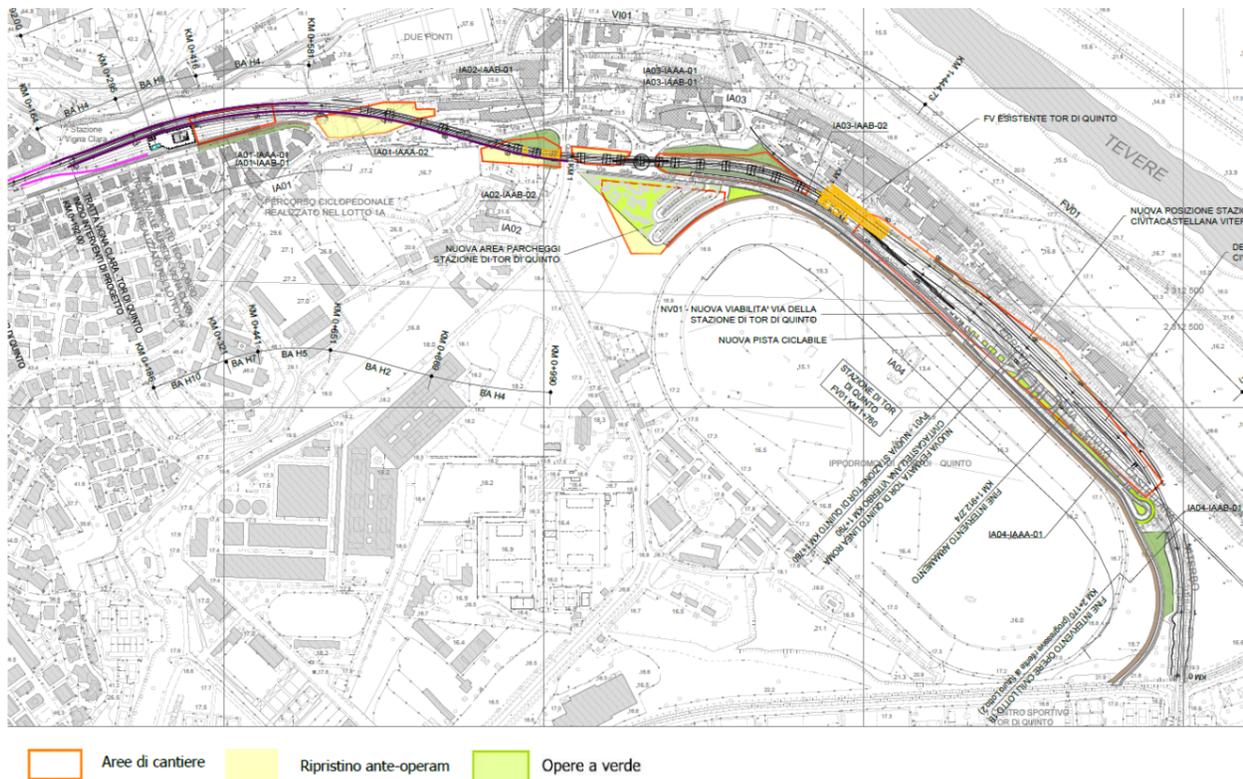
Stralcio Planimetria degli interventi di mitigazione
